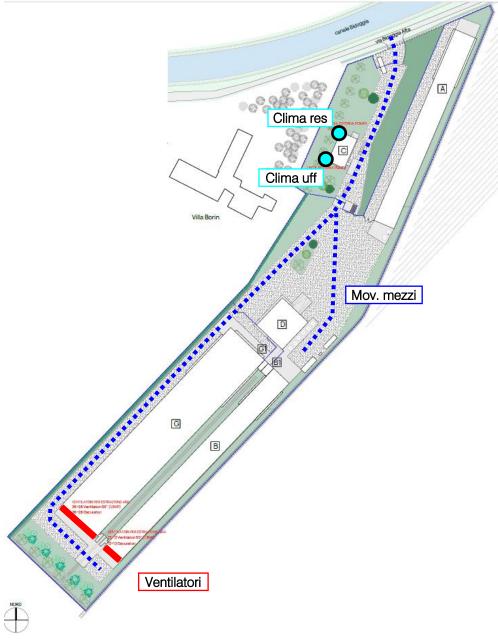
Planimetria dell'allevamento nella configurazione di progetto con individuazione sorgenti sonore.
